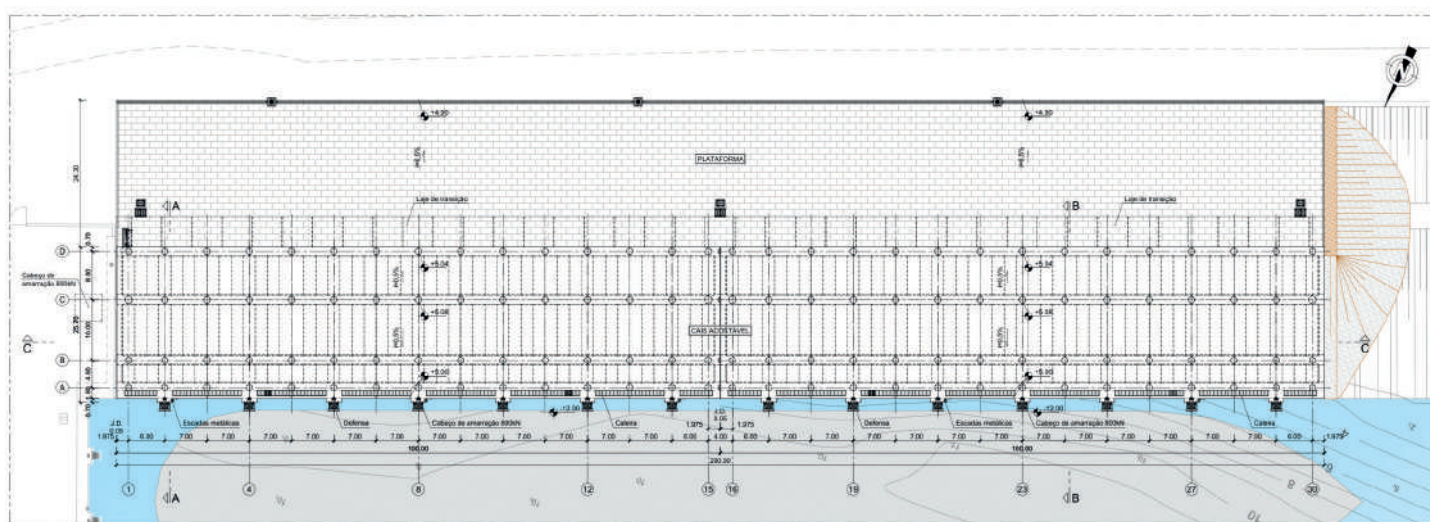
Planta geral do Cais. General plan of the quay structure.
